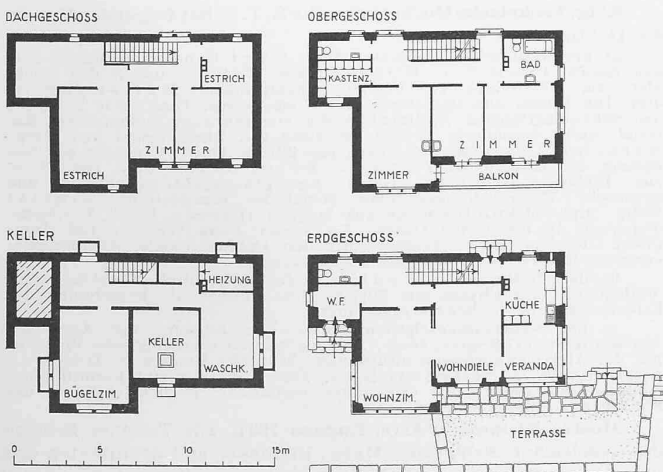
Grundrisse zum Hause Meinherz. — Masstab 1 : 400.
